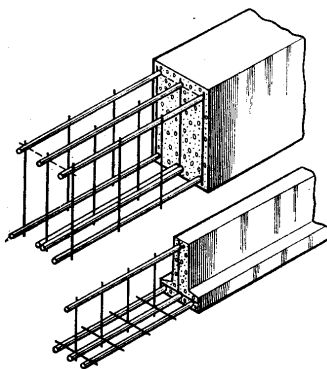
Армирование балок плоскими сварными каркасами
